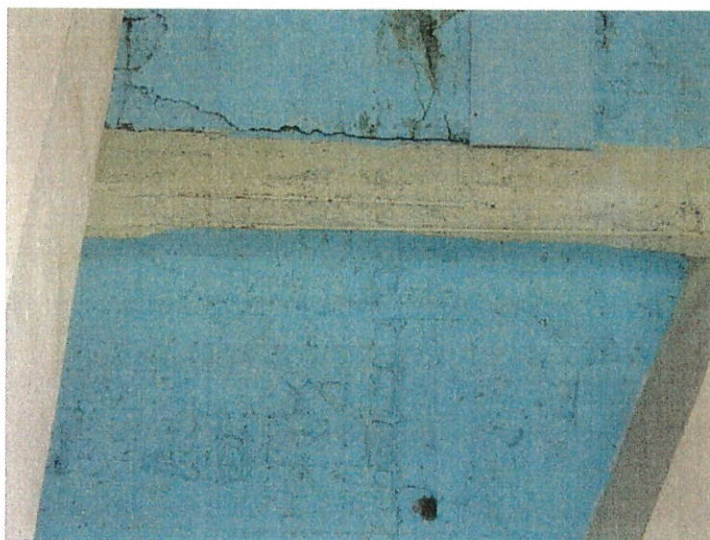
Église - Poutre et dalle fortement détériorées, infiltration constante d'eau
